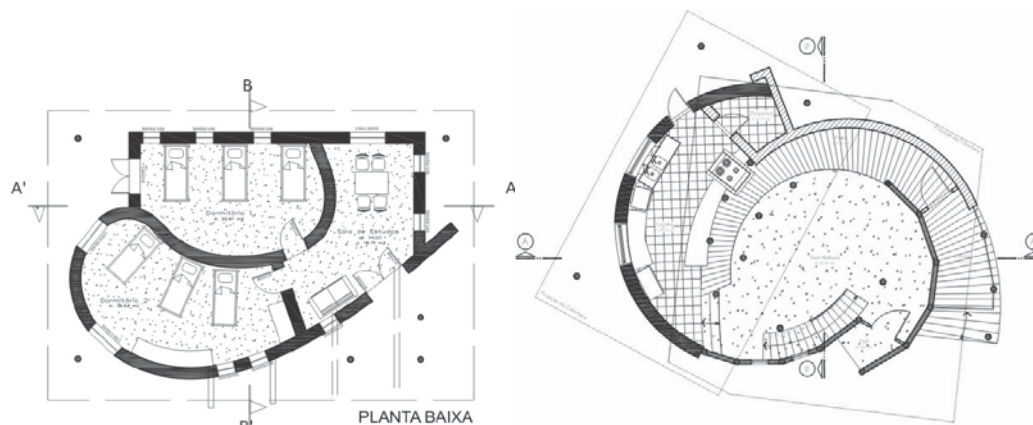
Planta Baixa Alojamento Feminino e Casa Mãe – IMCA
